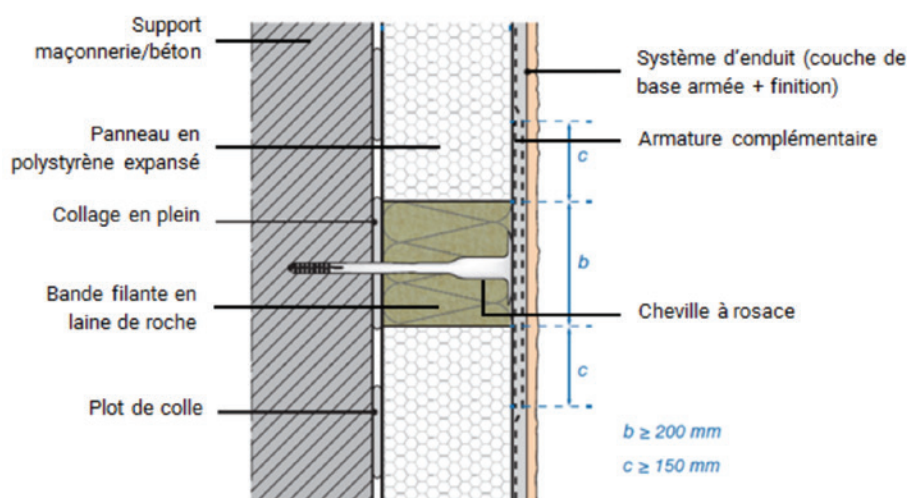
Principe de fixation des bandes filantes sur béton ou maçonnerie (coupe verticale)
